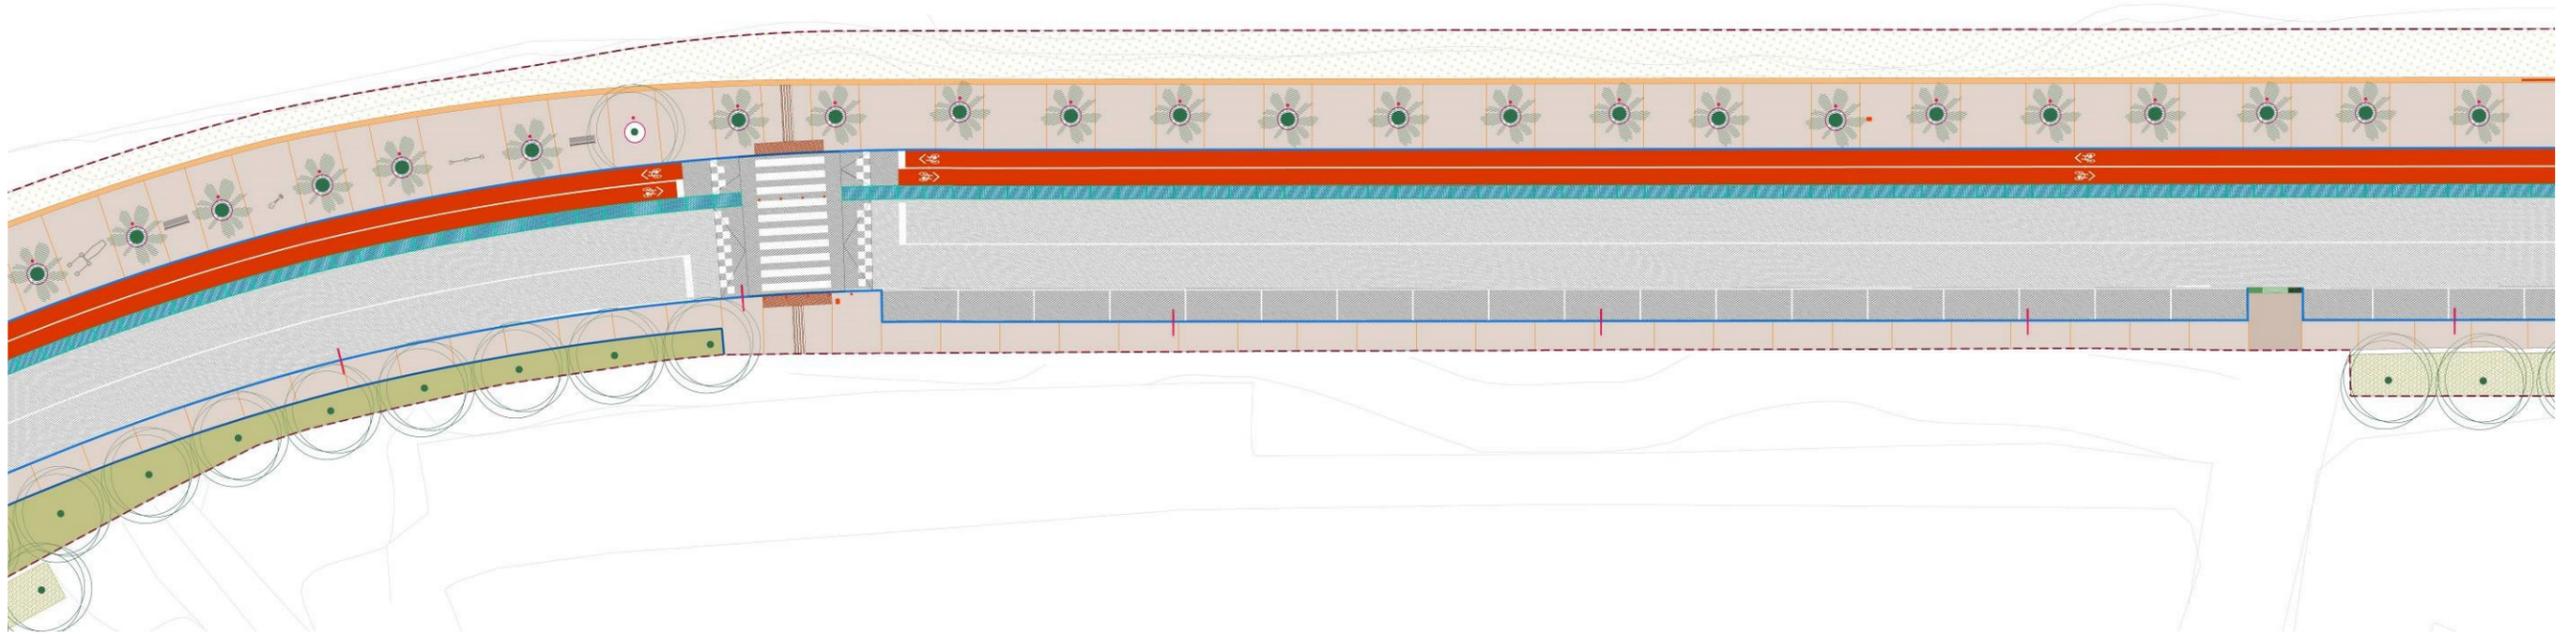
Plano Geral de Intervenção - Secções 6 e 7
